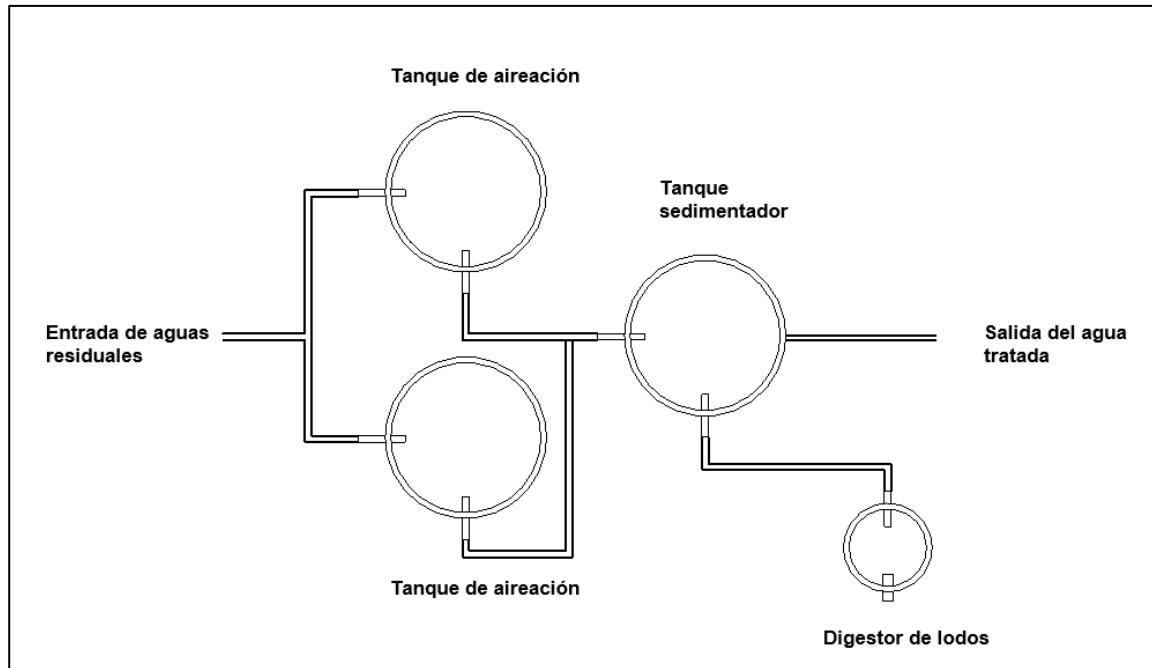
Vista en planta del sistema de lodos activados [Baque & Zavala, 2021]
